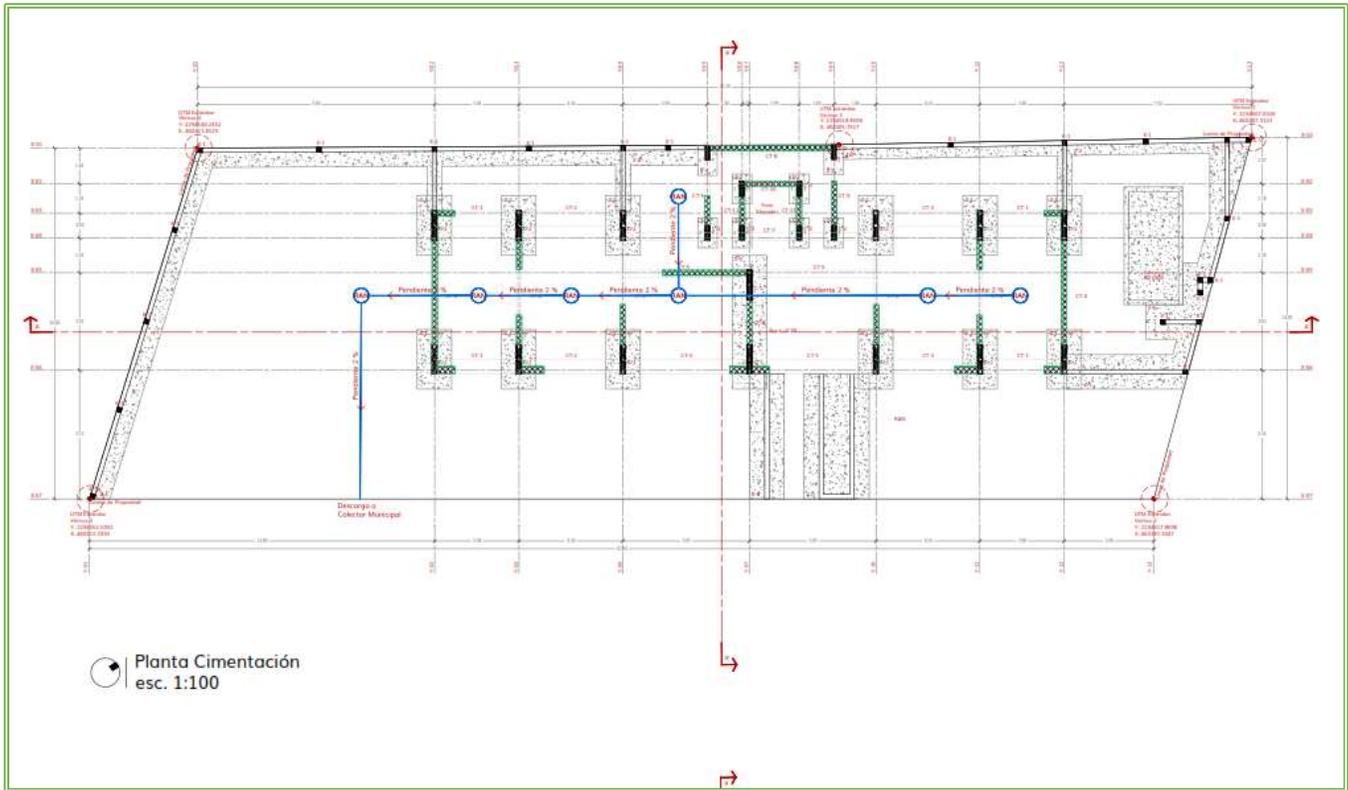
Detalle del diagrama del polígono Planta de Cimentación
